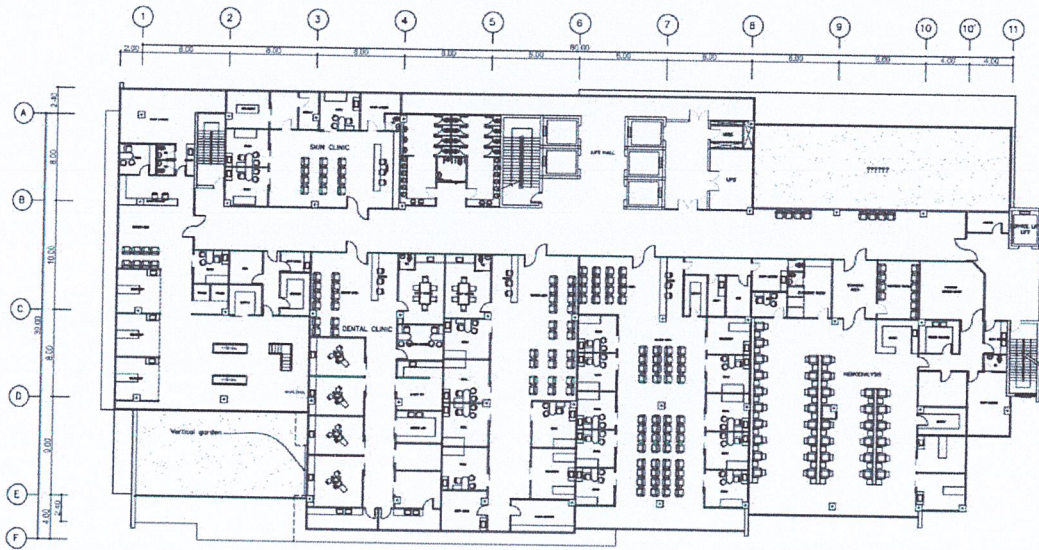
1<sup>st</sup> Floor Plan
